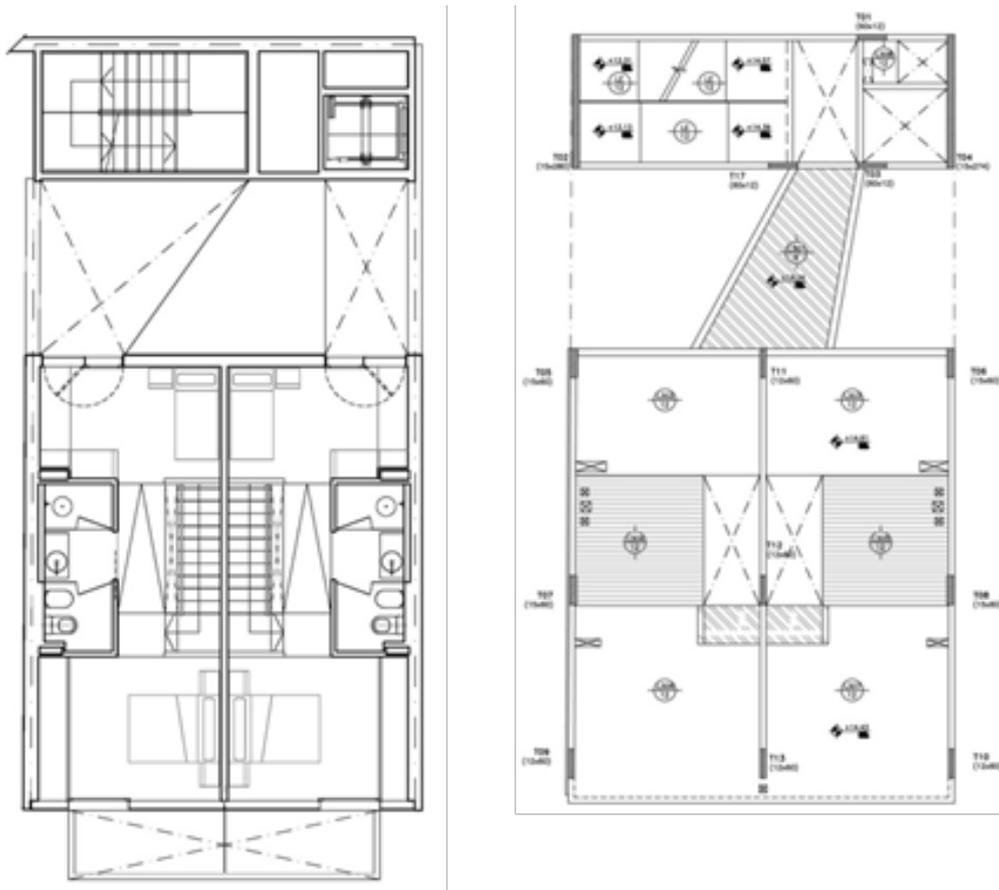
Planta de arquitectura y planta de estructura del nivel superior de los Dúplex. Fuente: Estudio de arquitectura A3 Digital
